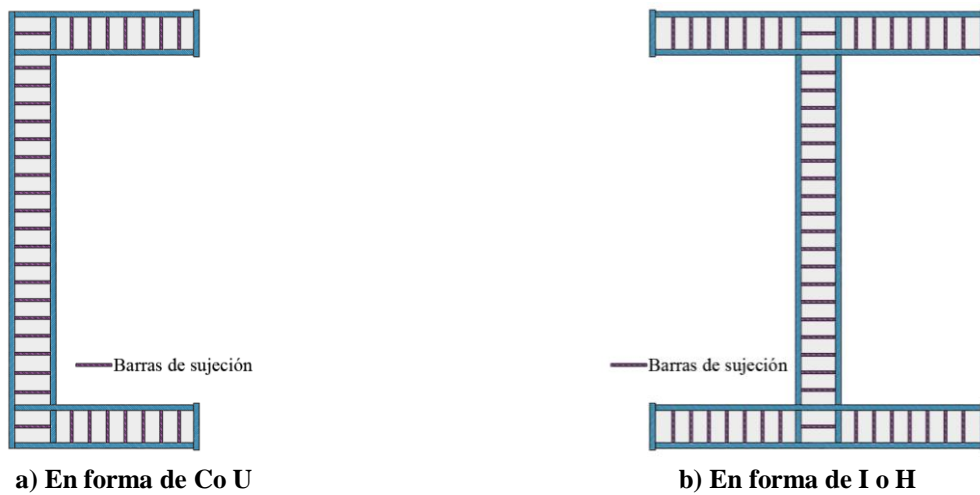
a - Muros de cortante no planos en sección compuesta
